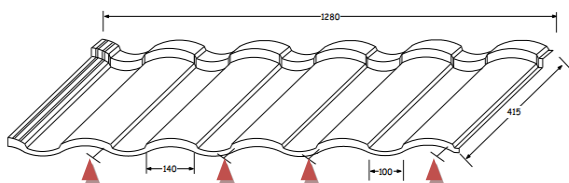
METROTILE® SHAKE dakpan - plaatsing van de bevestigingen
